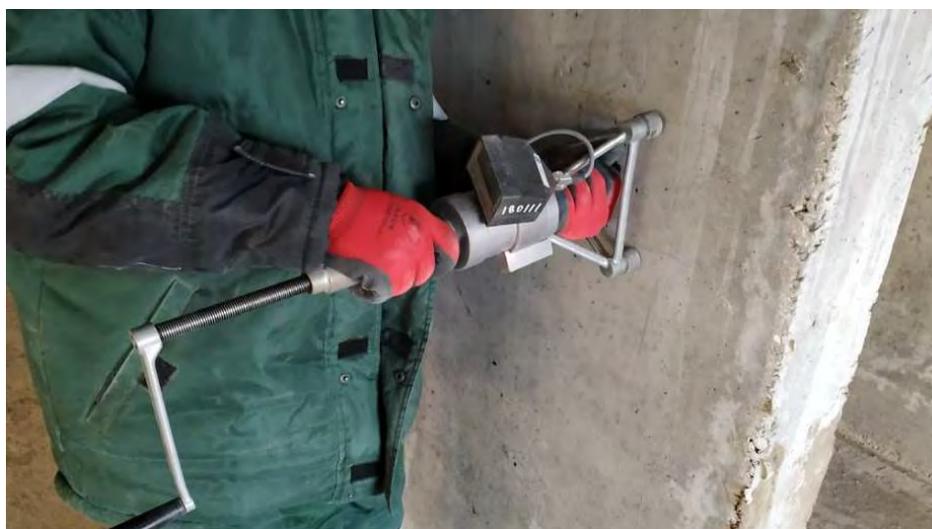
Установка прибора ПОС 50МГ-4 для проведения испытания в монолитном железобетонном пилоне в осях бс2-7с2/Вс2
